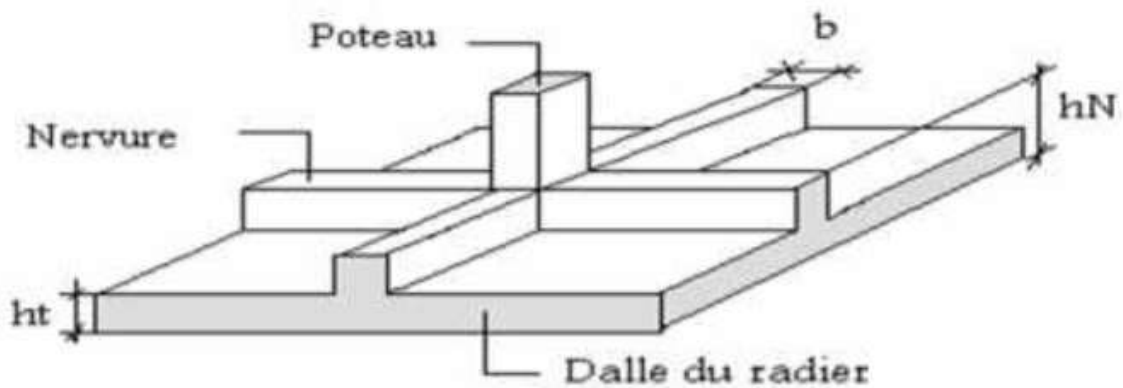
Disposition des nervures par rapport au radier et aux poteaux
